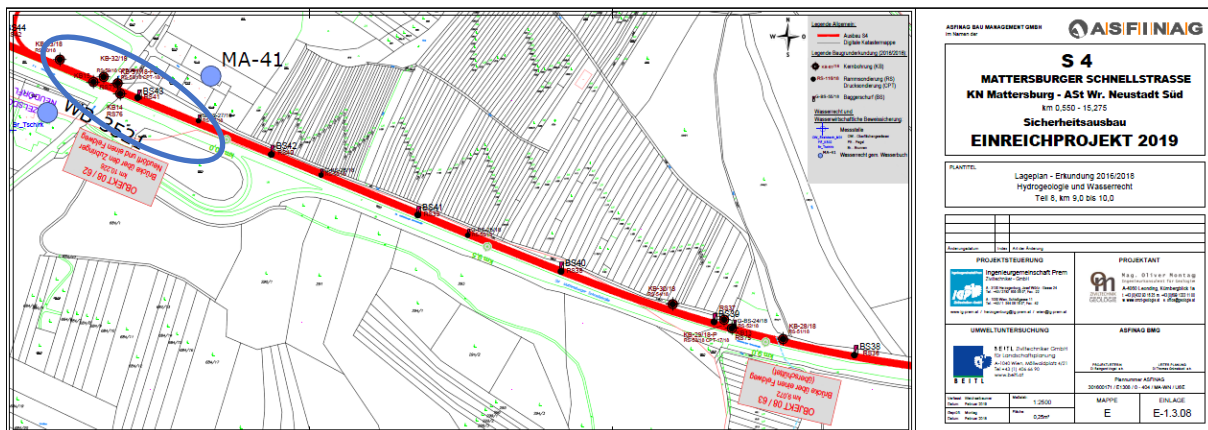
Kernbohrung 32 - Lageplan
